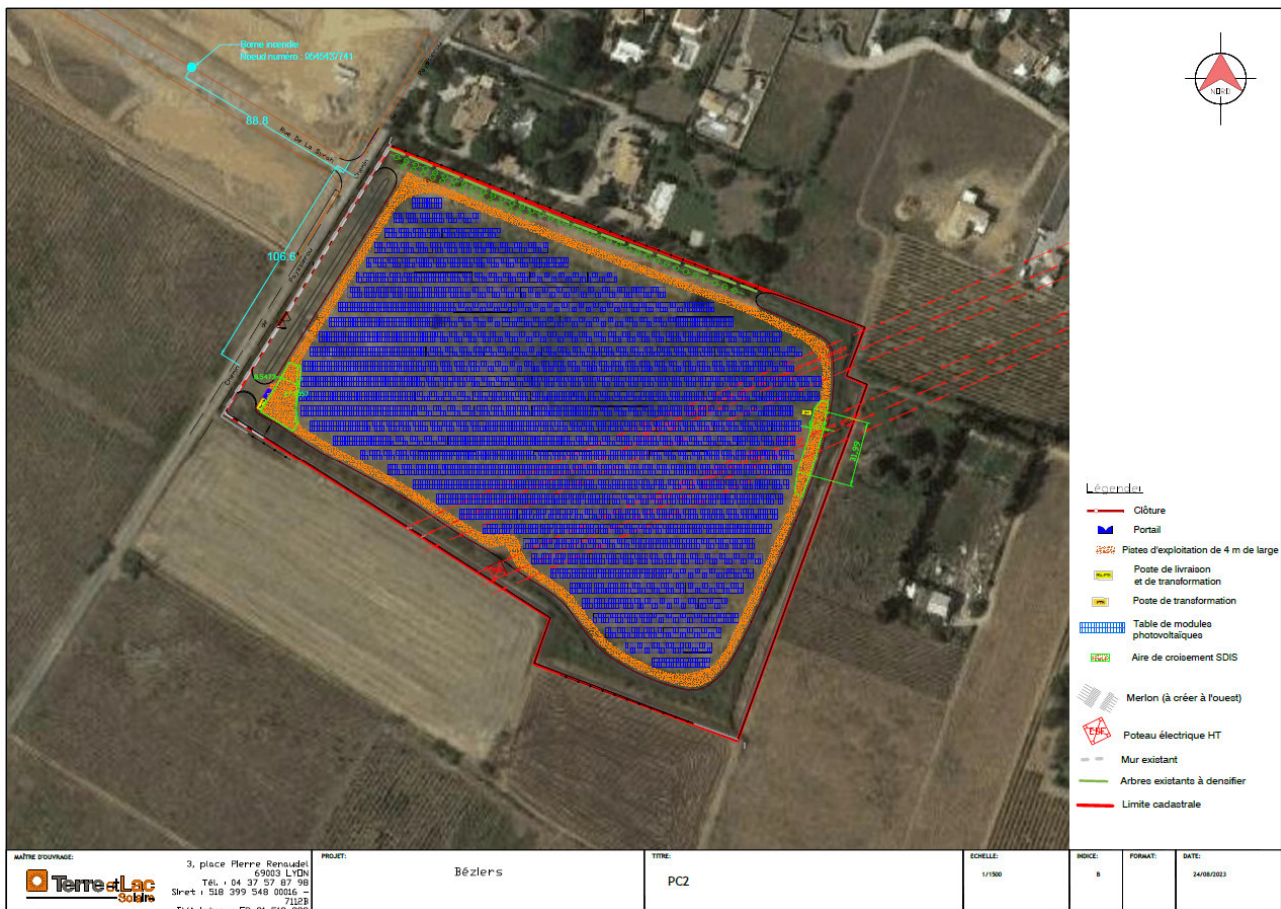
PLAN DU PROJET SANS ECHELLE DATE DU 24/08/2023 (SOURCE : CORFU SOLAIRE)
